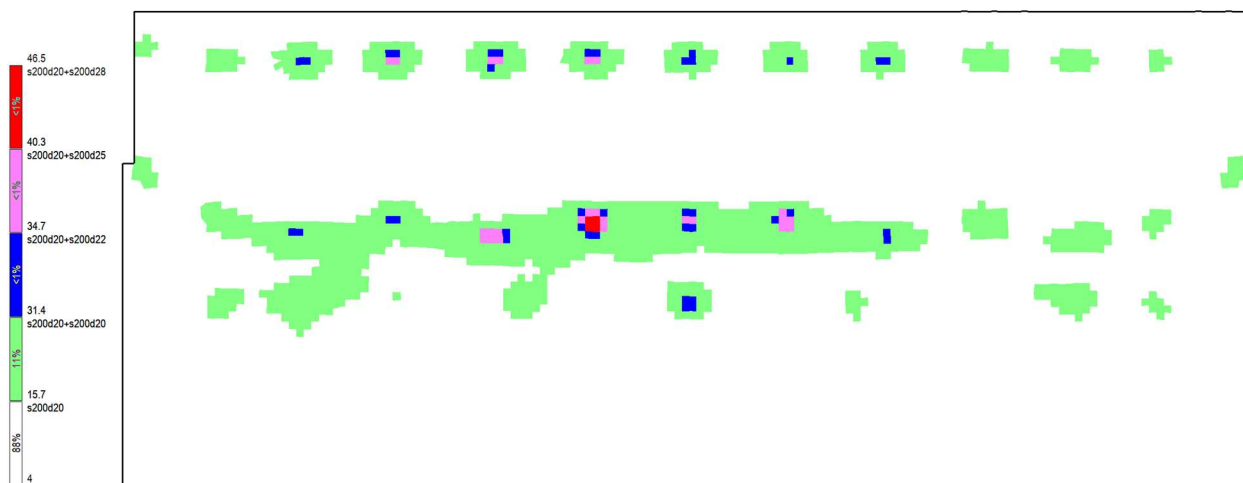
Розрахункові зони армування нижньої зони вздовж осі «Y» для першого варіанту розрахунку
